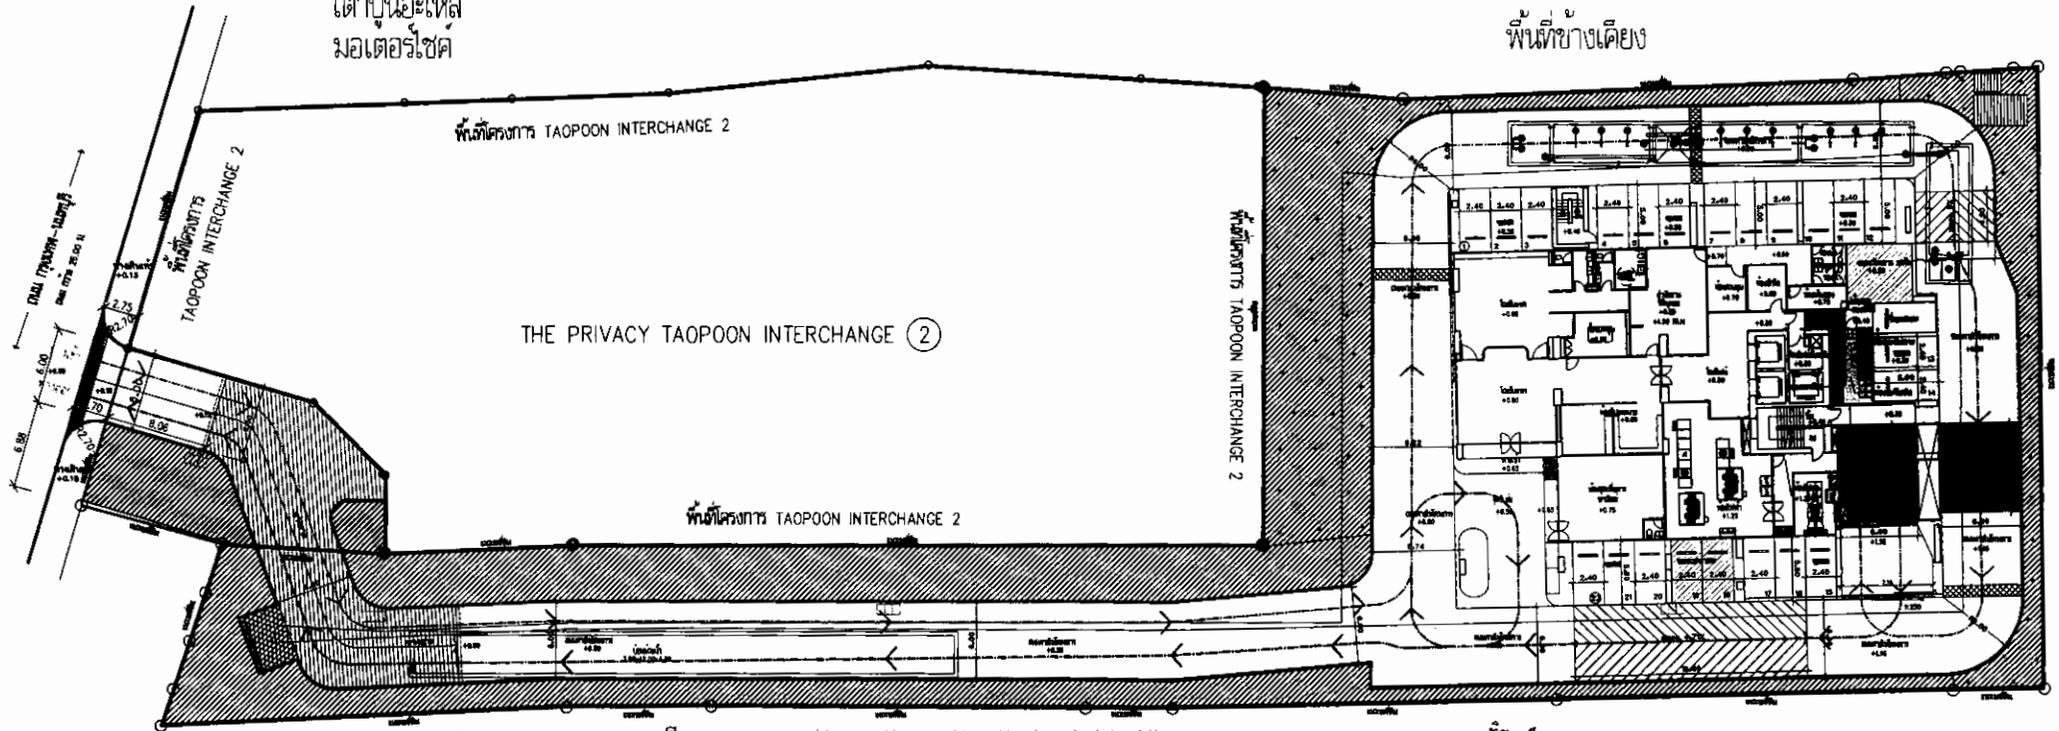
ผังโฉนดที่ดินของโครงการ
